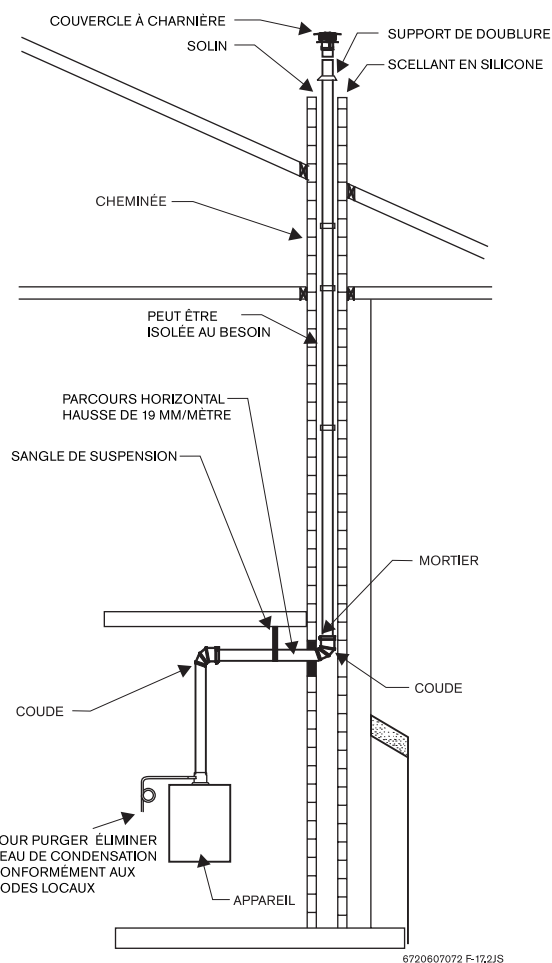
Installation du conduit à la verticale - cheminée de maçonnerie (conduit d'air comburant non illustré)
